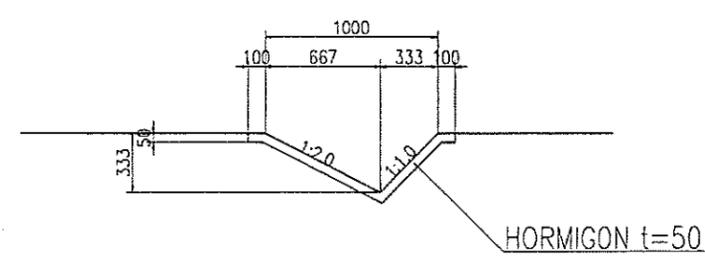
Planos Estructurales ed La Superestructura, Estribos Y Pila
